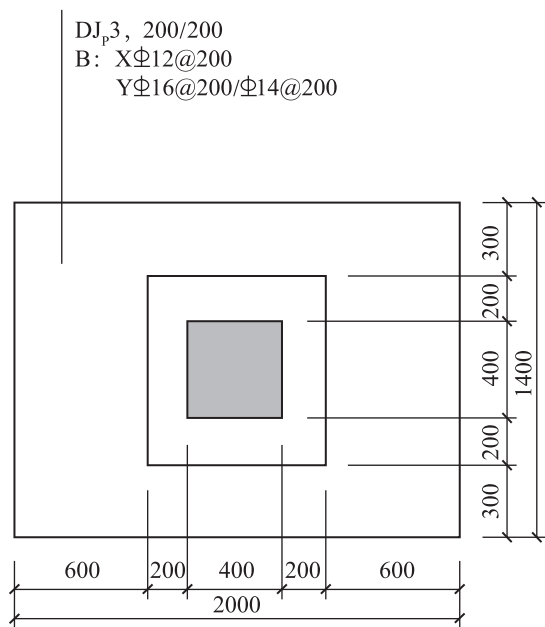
矩形独立基础底板底部的短向配筋平面示意图
